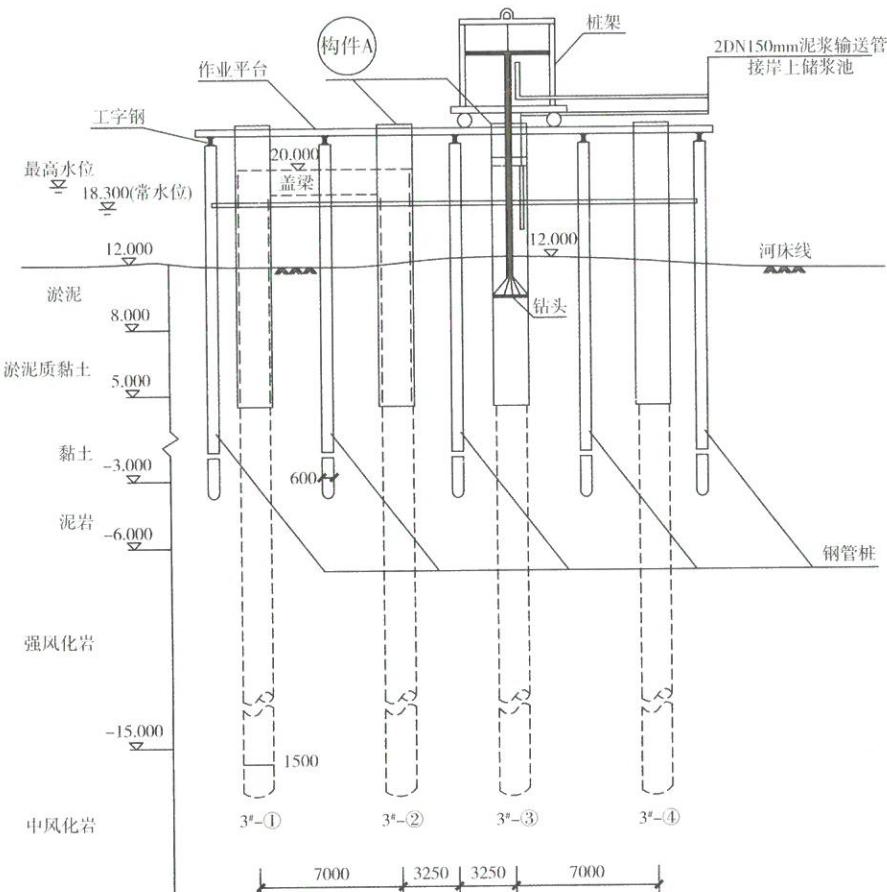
3#墩水上作业平台及桩基施工横断面布置示意图
